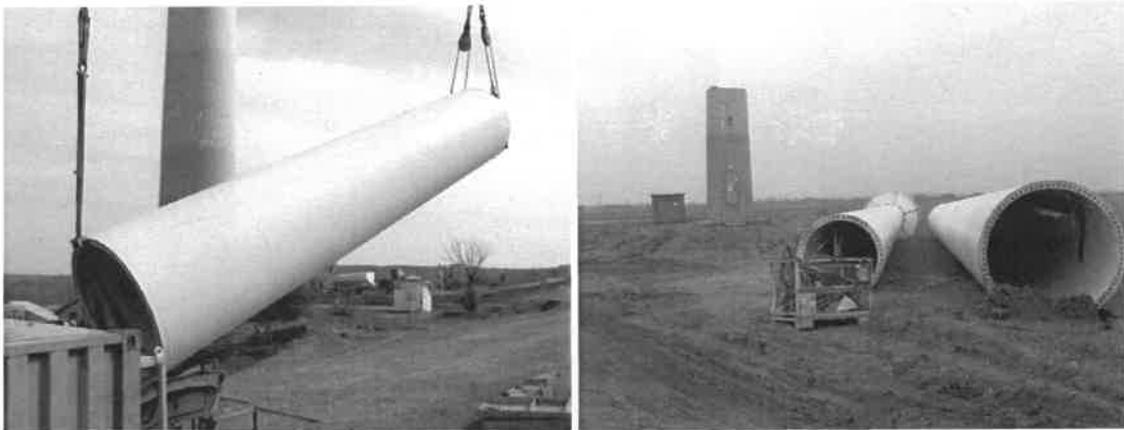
Dépose d'une section en acier (à gauche), sections d'acier démontées (à droite)
